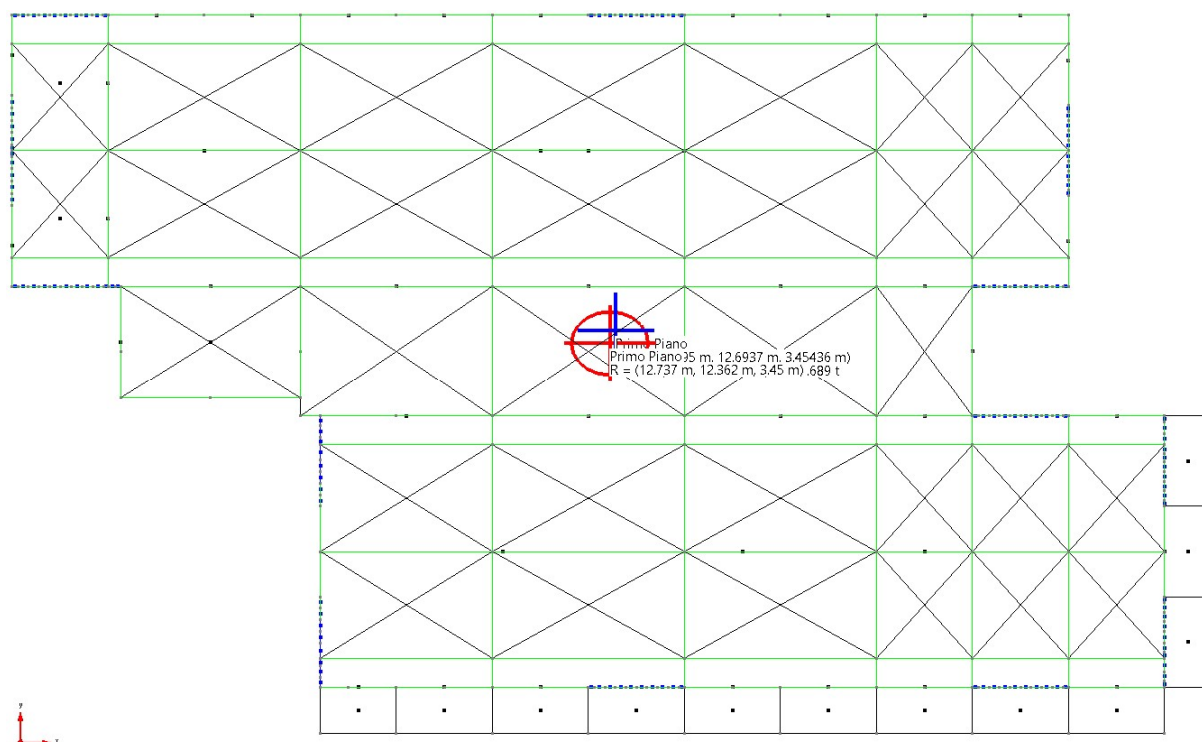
Stato di Progetto : posizione del baricentro delle masse G e delle rigidezze R al primo impalcato.
